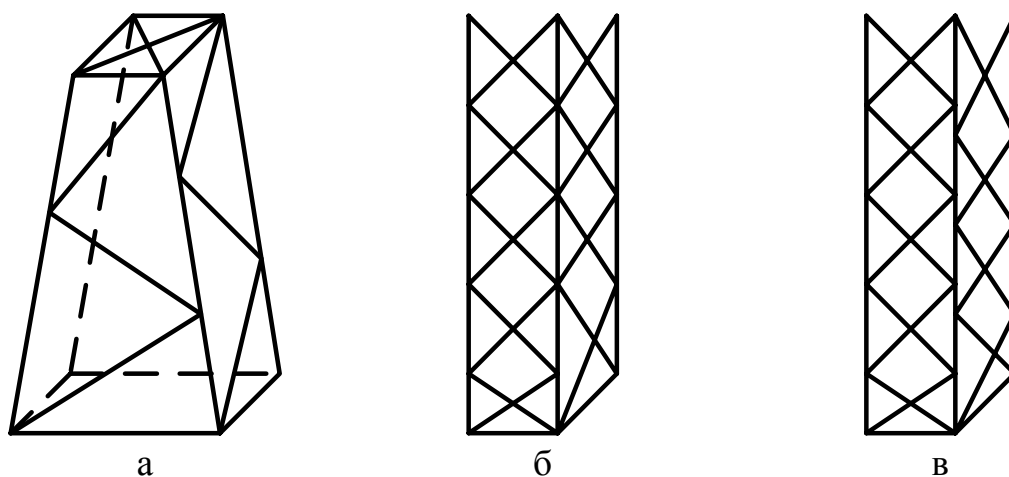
Ствол опоры с решеткой: а – «в елку»; б – с перекрестной решеткой; в – с перекрестной решеткой со смещением узлов в смежных гранях
